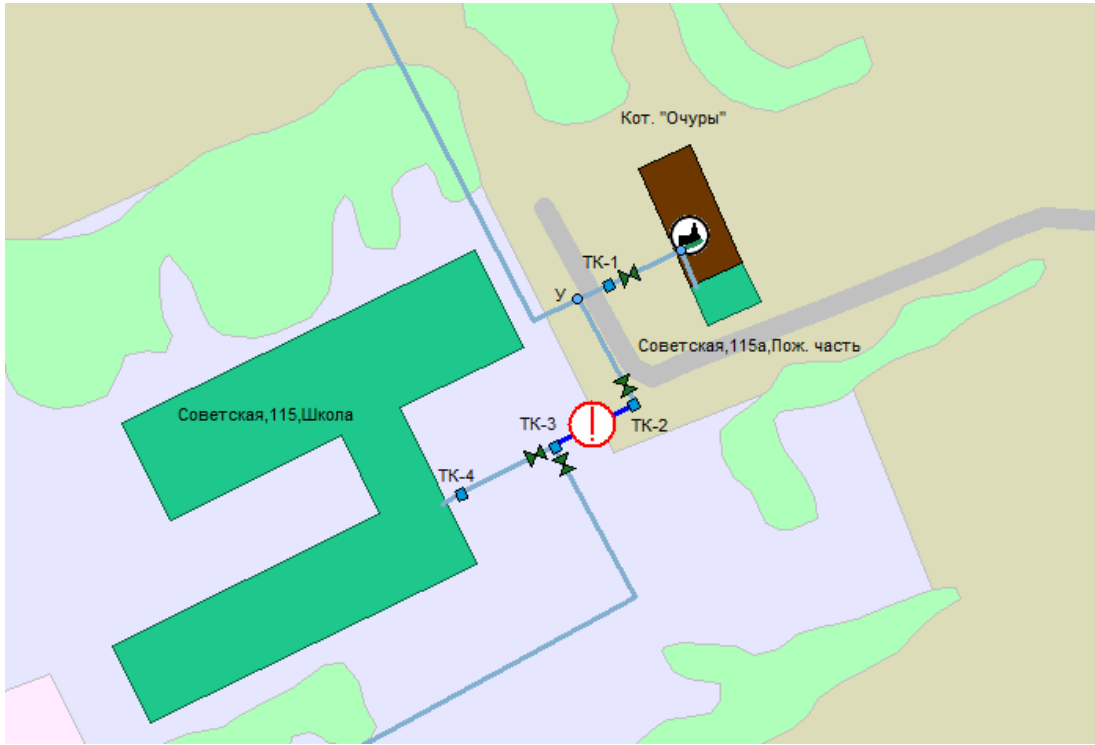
Трубопроводы, перекрытые для проведения ремонтных работ.
